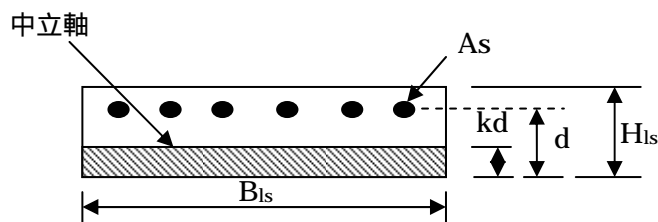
ひび割れ発生後の連結床版の断面
